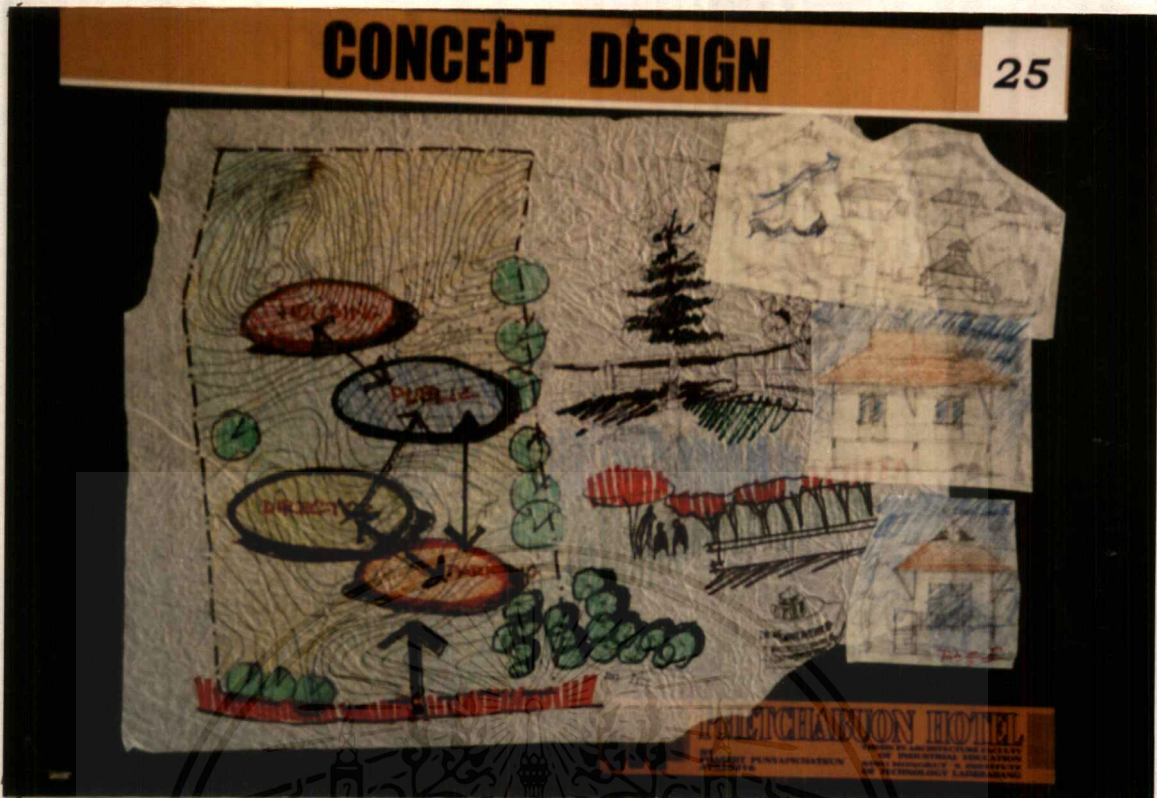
พังแสดงการติดต่อสัญจรของโครงการ
